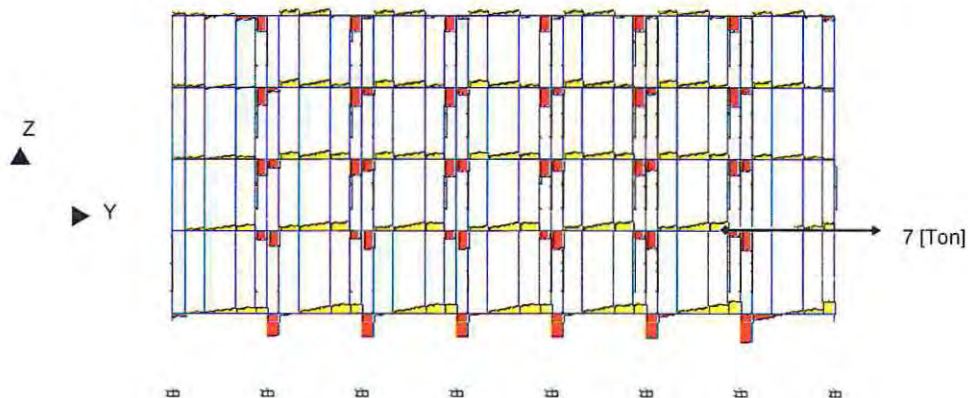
Diagrama de corte en vigas de fachada, eje A, estructura aislada.
